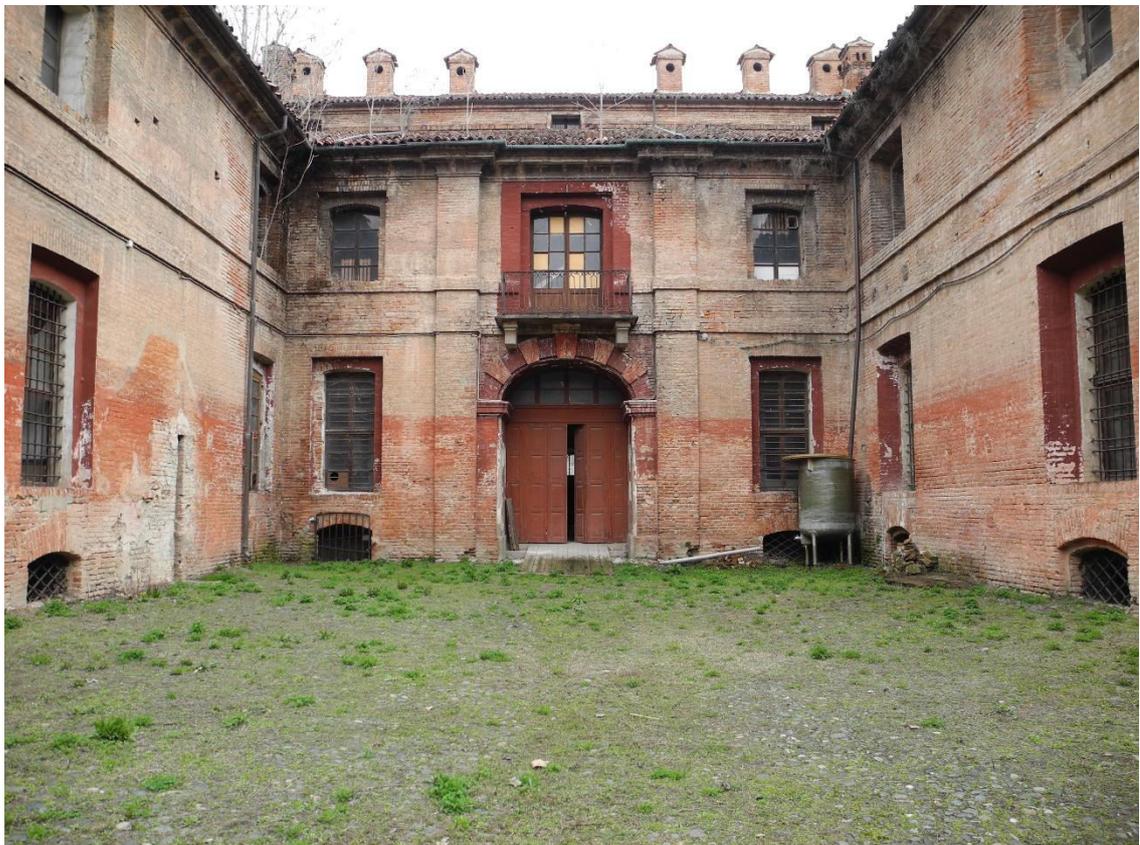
Cortile centrale. Vista dal centro verso la manica principale.
